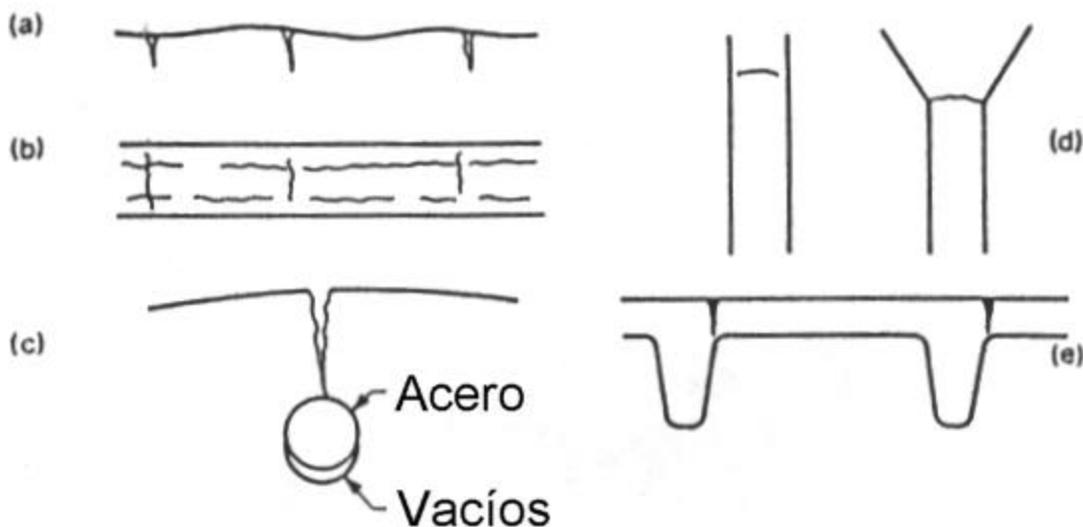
Grietas por asentamiento plástico: (a) Elevación; (b) Planta; (c) Detalle; (d) Columna; (e) Trough % Waffle.
